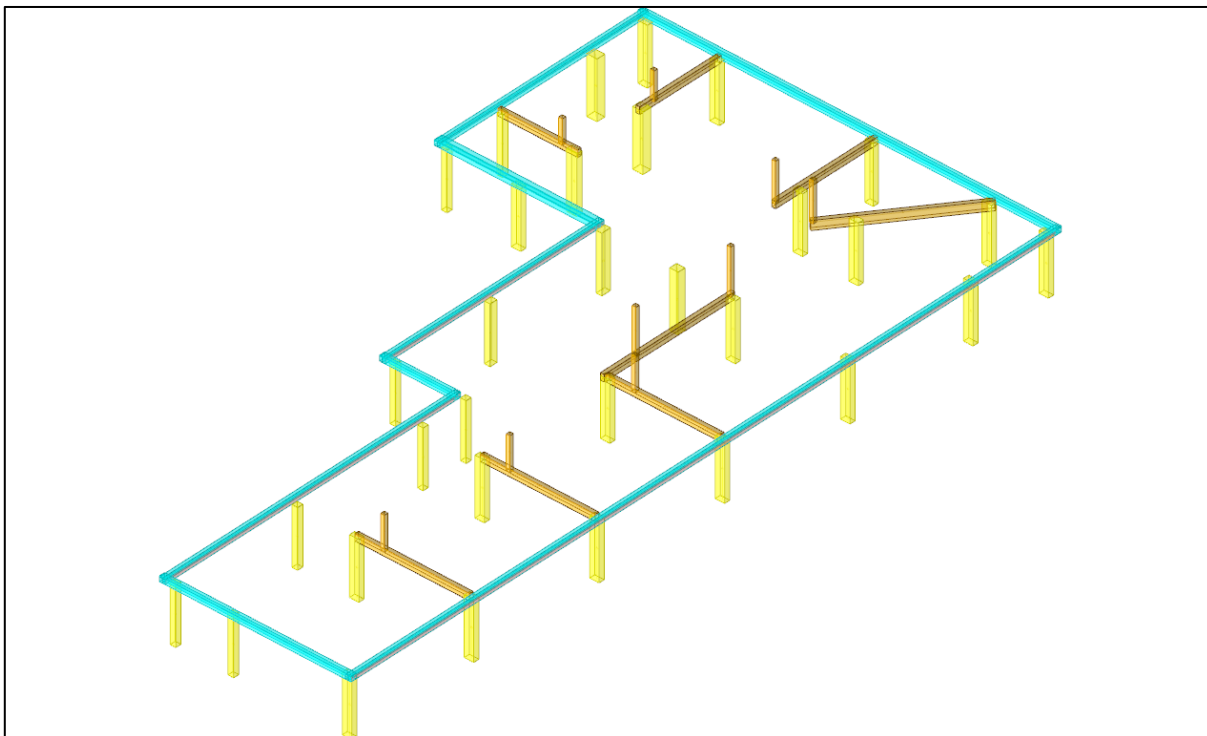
struttura a quota secondo impalcato di appoggio alla copertura
